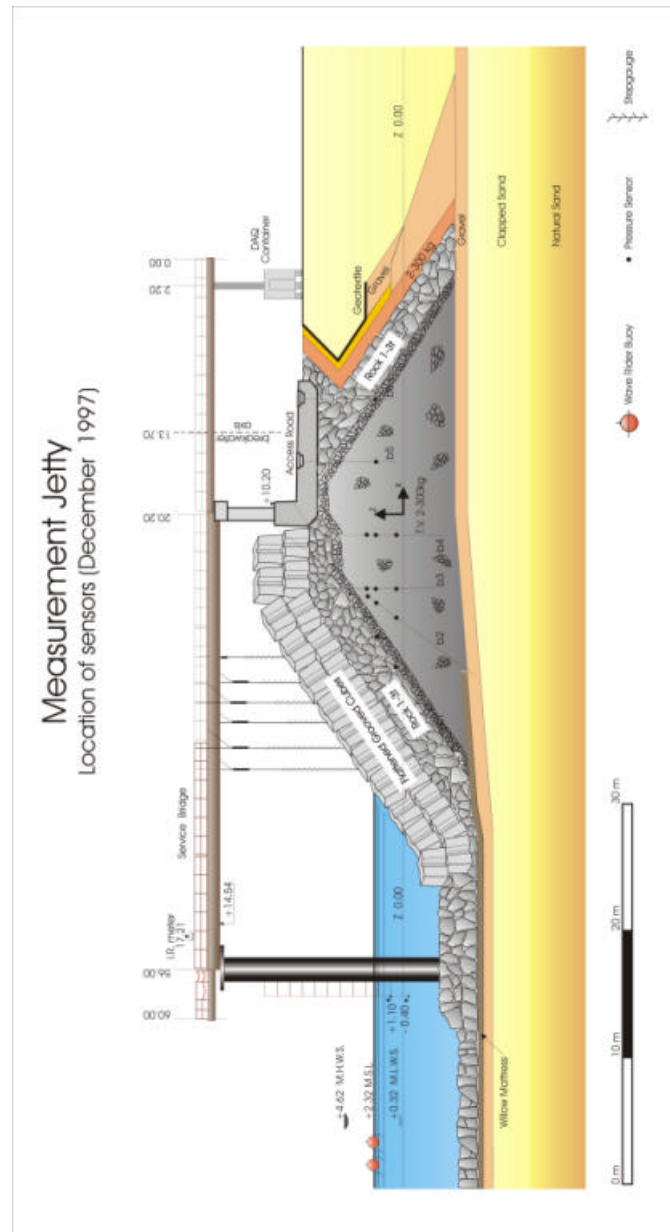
Dwarsdoorsnede van de stortsteengolfbreker te Zeebrugge, ter plaatse van de sectie met de prototype meetopstelling, met overzicht van de geïnstalleerde instrumentatie.
